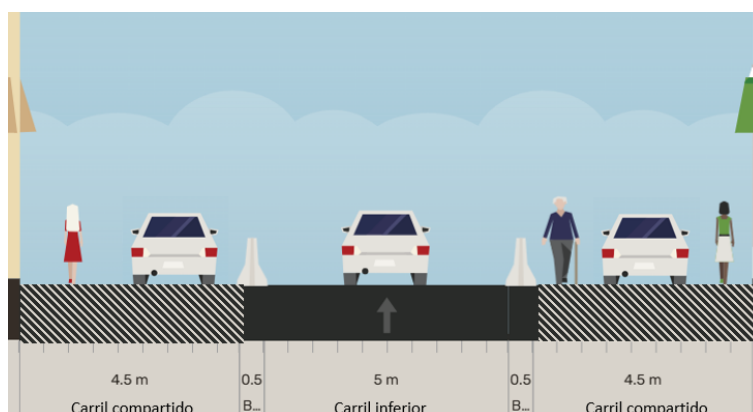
Esquema de sección transversal para pasos inferiores de calles transversales con dos carriles inferiores.
